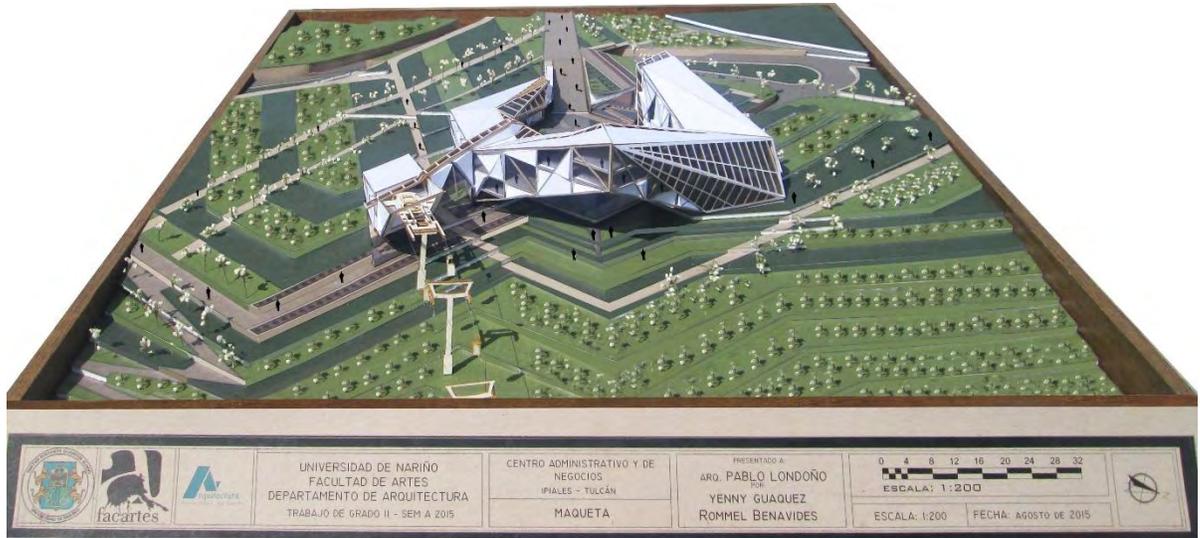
Fotografía de maqueta final vista Norte. Fuente: Elaboración propia
